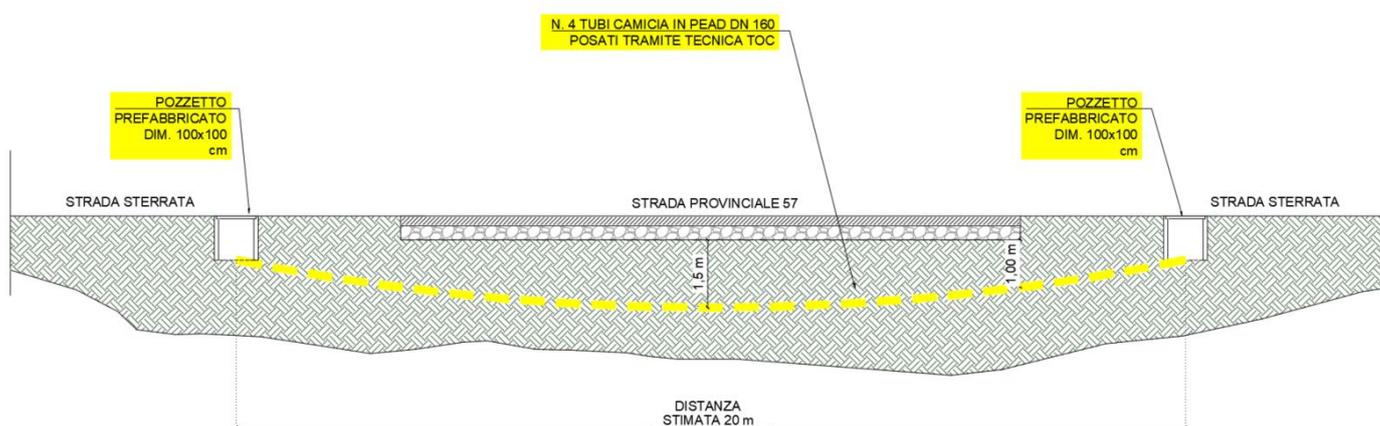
Sezione posa cavidotto tramite tecnica T.O.C.
